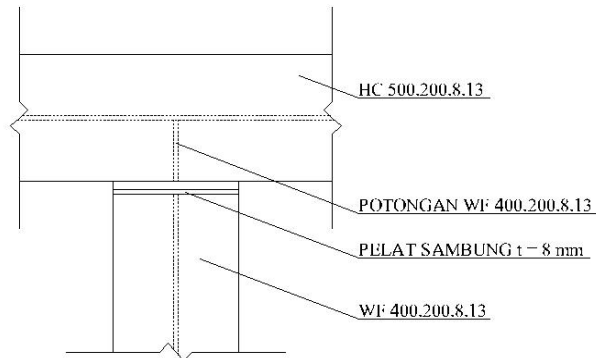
Detail sambungan balok anak atap – balok induk atap
